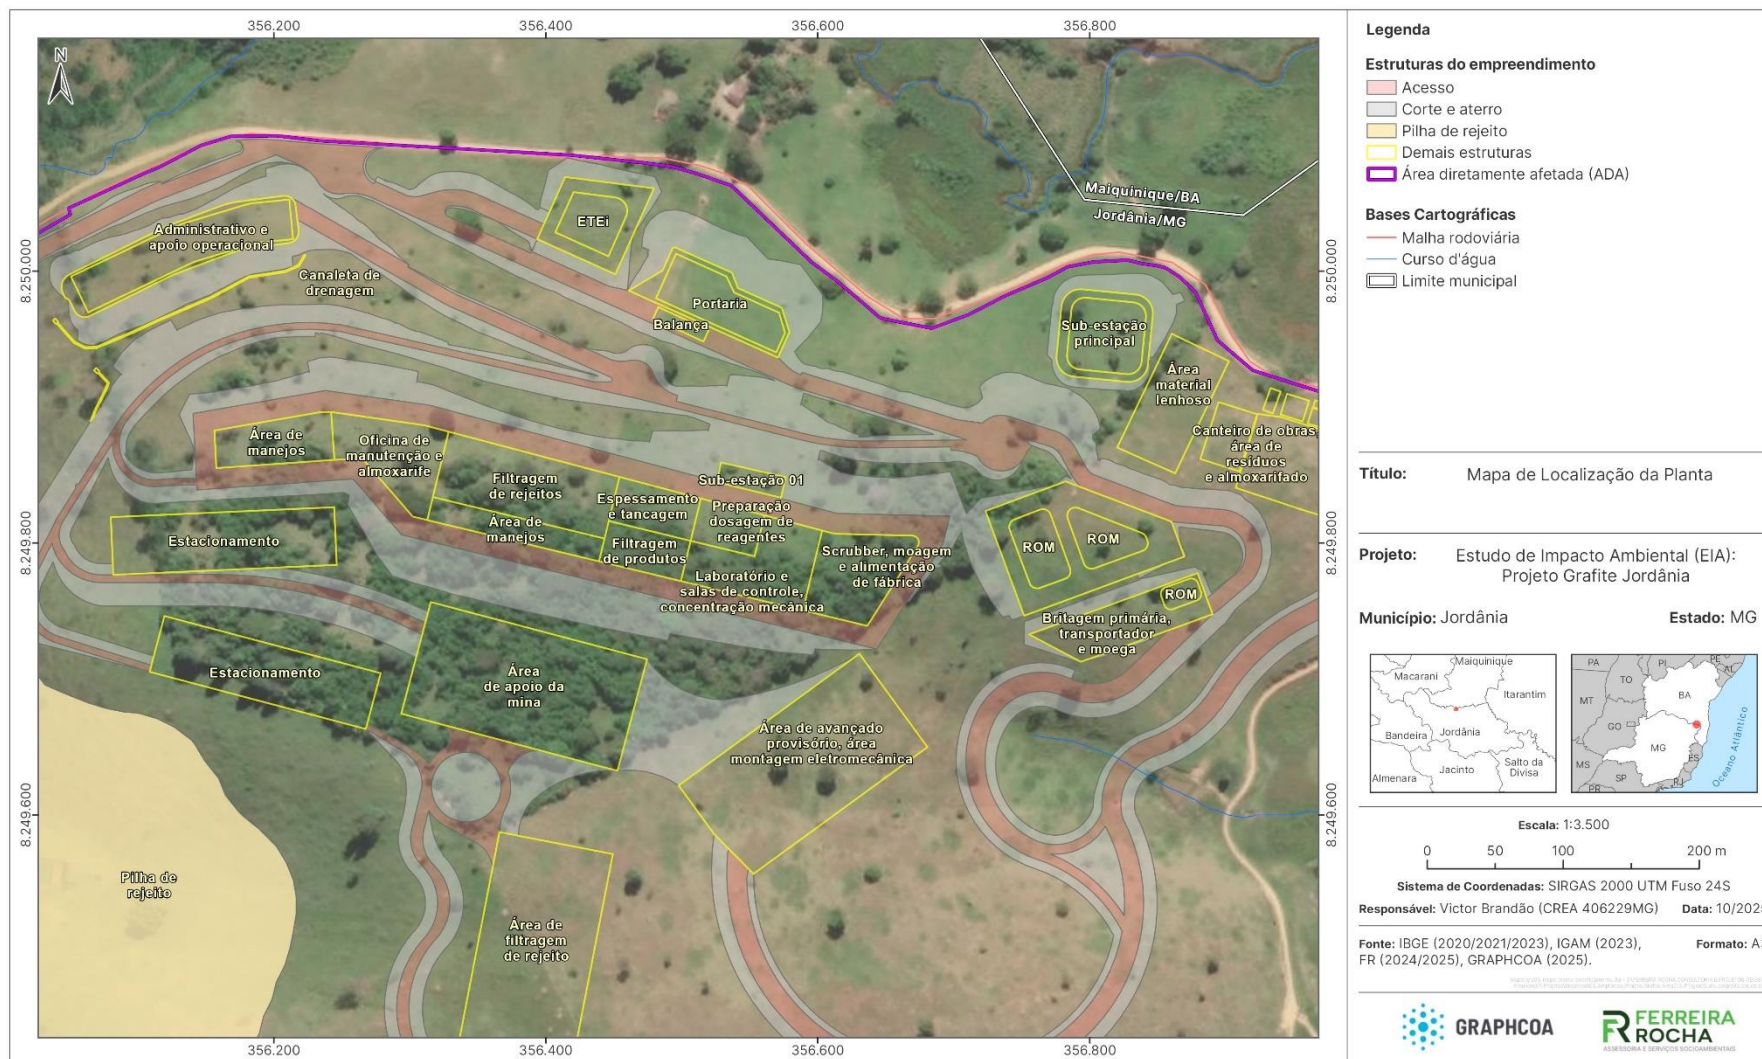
Layout geral da planta de beneficiamento do Projeto Jordânia.
